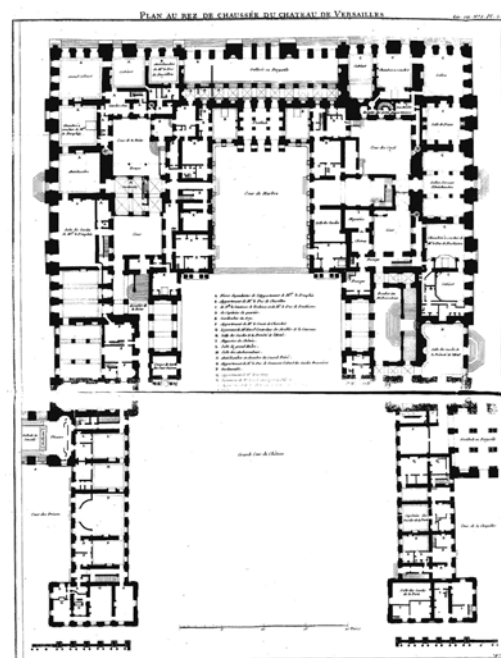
Planta del palacio de Versailles. Fuente: Blondel (1756).
